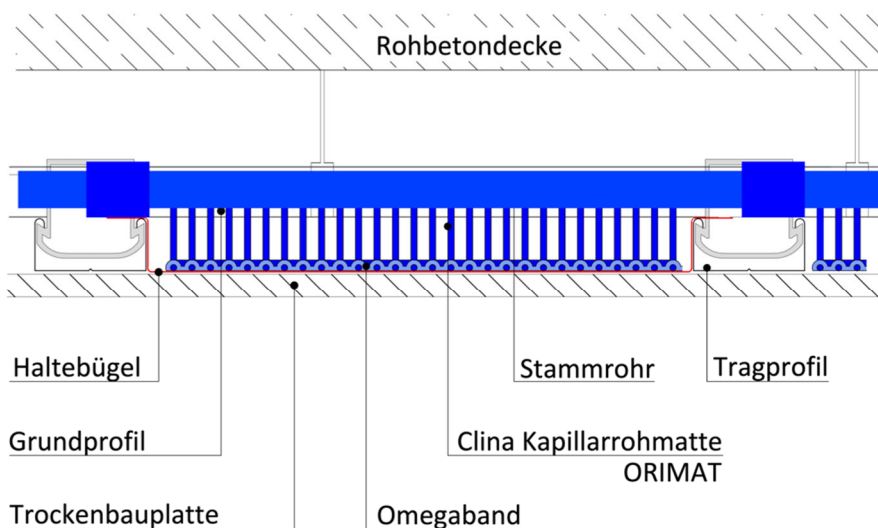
Schnittbild Deckenaufbau mit Haltebügel quer
